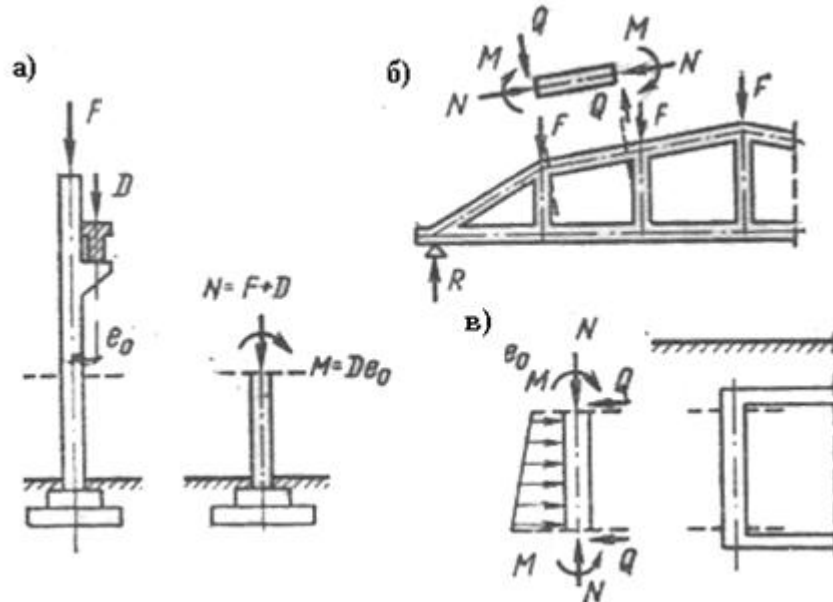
Стиснуті елементи: а – колона, б – верхній пояс ферми, в – стіна підземного резервуара
